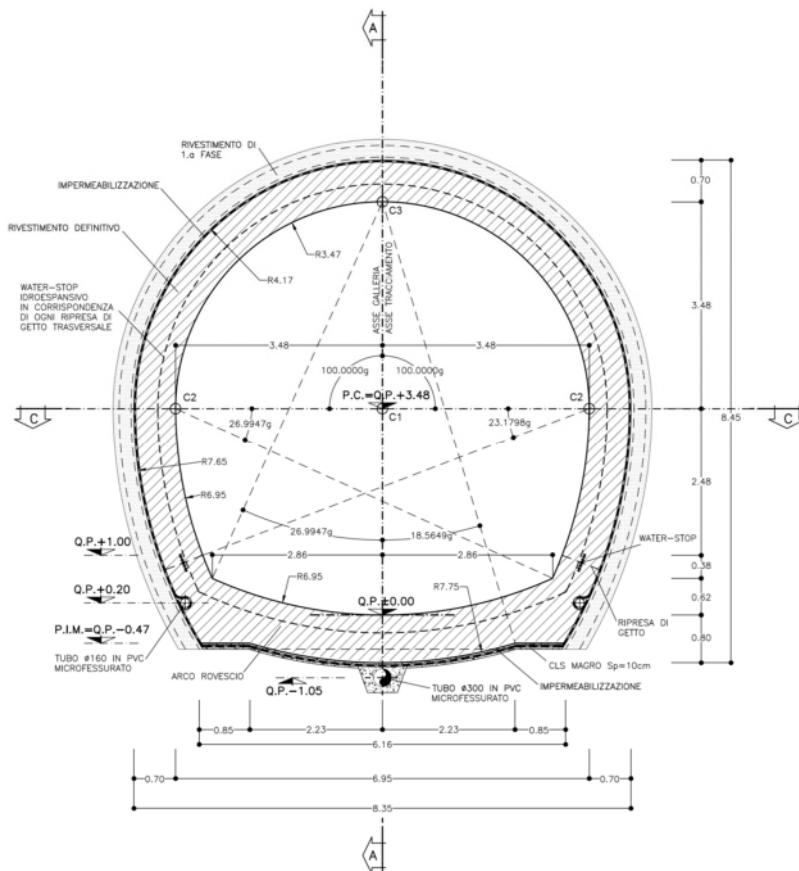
Sezione Tipo C2 – Carpenteria – Sezioni
